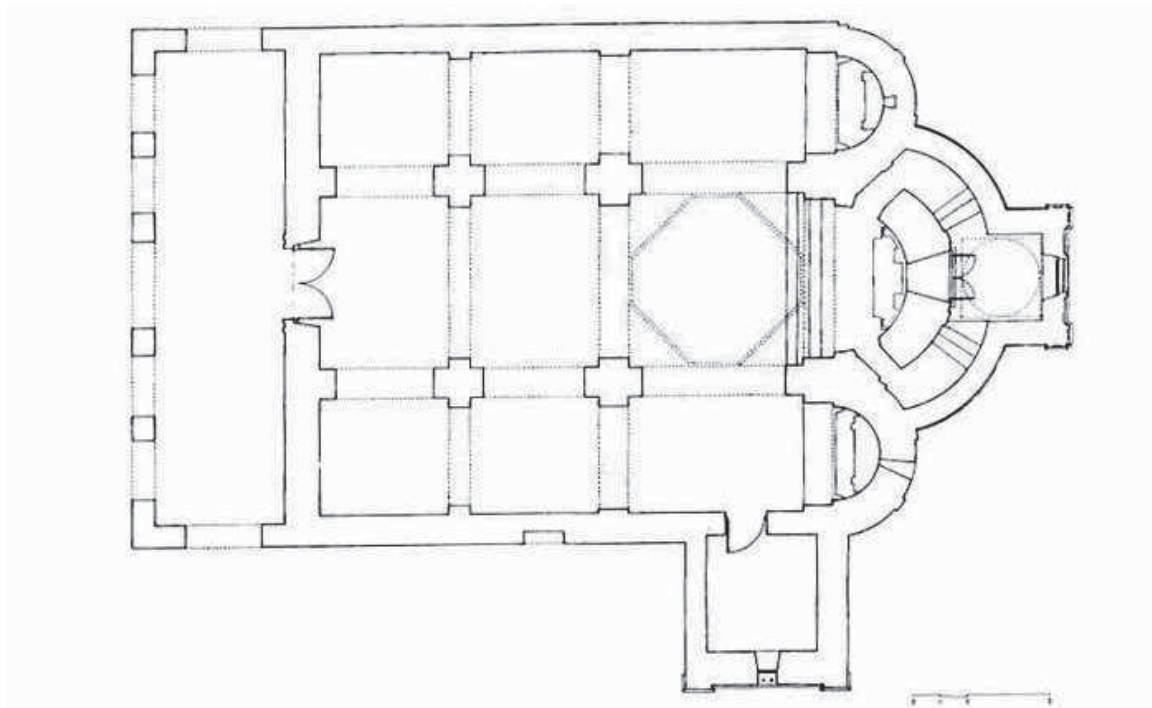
plano de la ermita de Urueña (fuente: www.arquivoltas.com)
